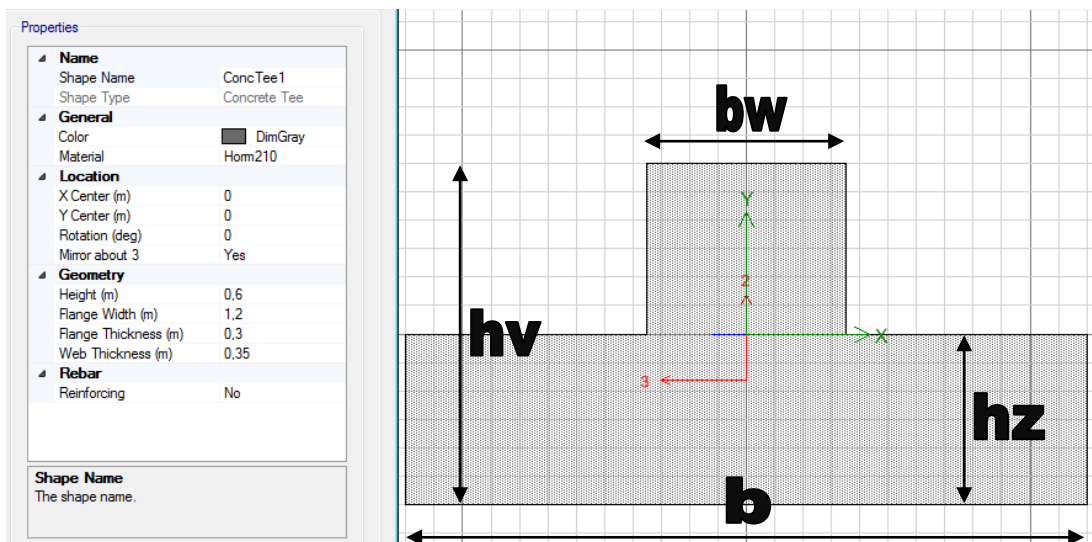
Sección VC1 viga de cimentación (Etabs2015)
